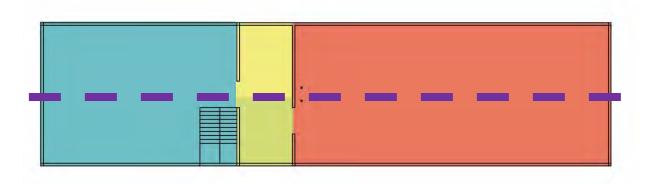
Planta baja, estación de bomberos voluntarios, Uruapan, Michoacán
